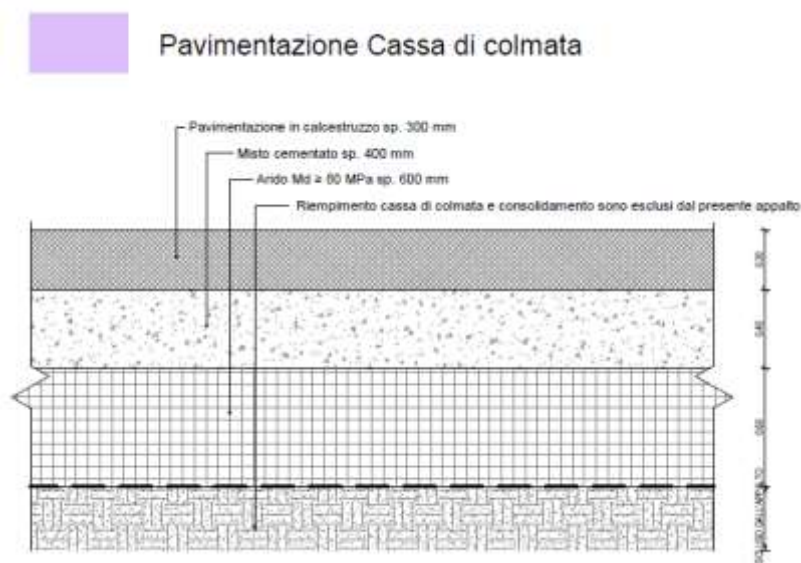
Sezione tipologica pacchetto pavimentazione nella zona della cassa di colmata (progetto Molo VIII)
